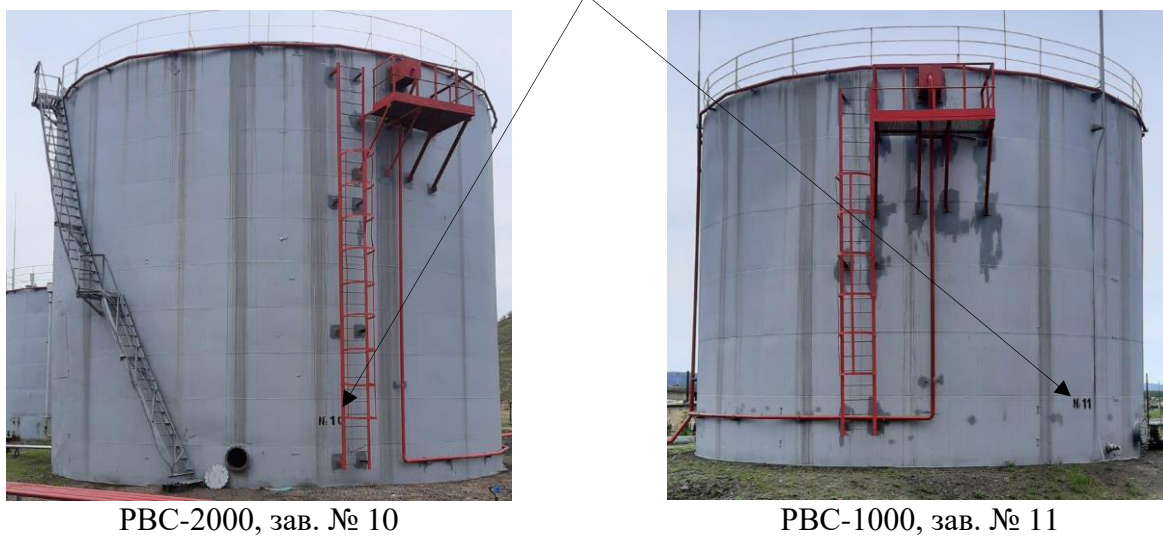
Общий вид резервуаров, зав. № 10, 11
